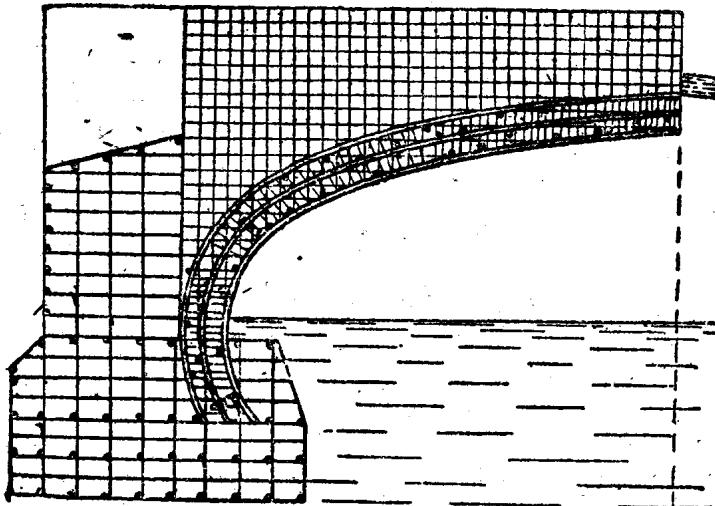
蒙約体系鋼筋混凝土橋梁的配筋
